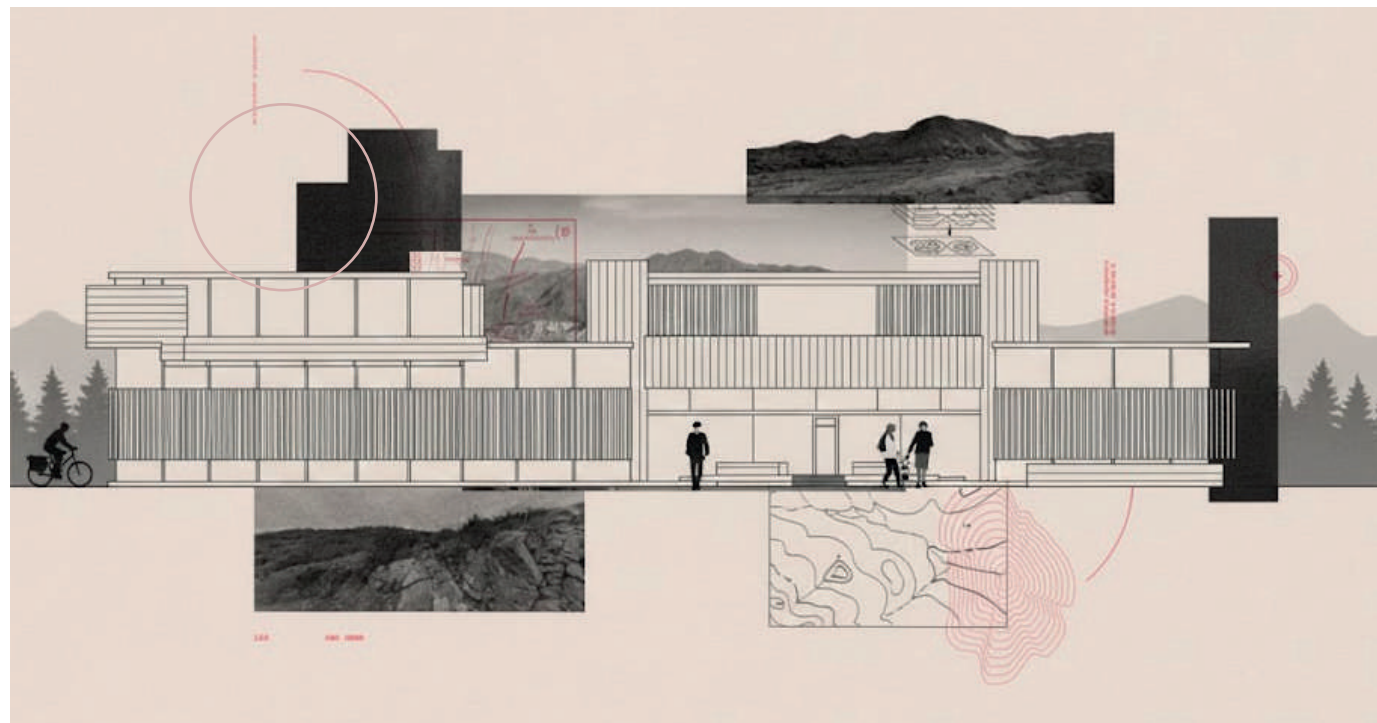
Collage de proyecto. Fuente: Elaboración propia. 2025
